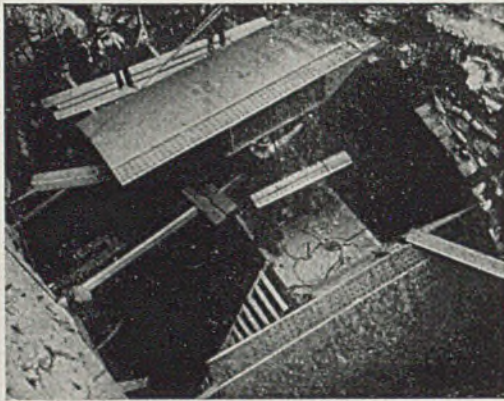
Schildmontage im New-Jersey-Schacht und Eindringen der Schildschneide in New Yorker Caisson.
